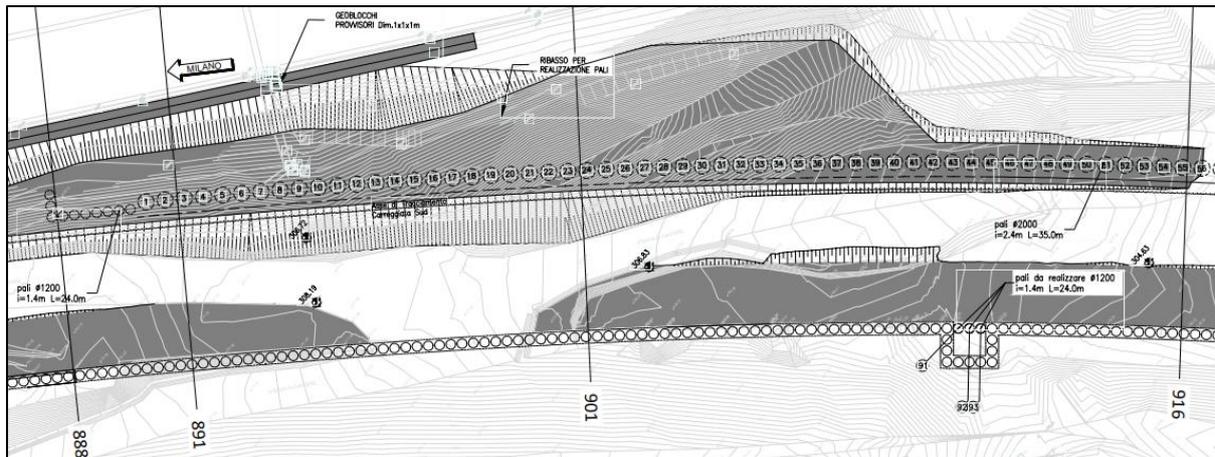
FASE 1 Planimetria area intervento (1 di 2)
